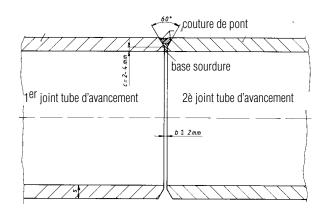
Tronçon de tube avec soudure en bout à bout
